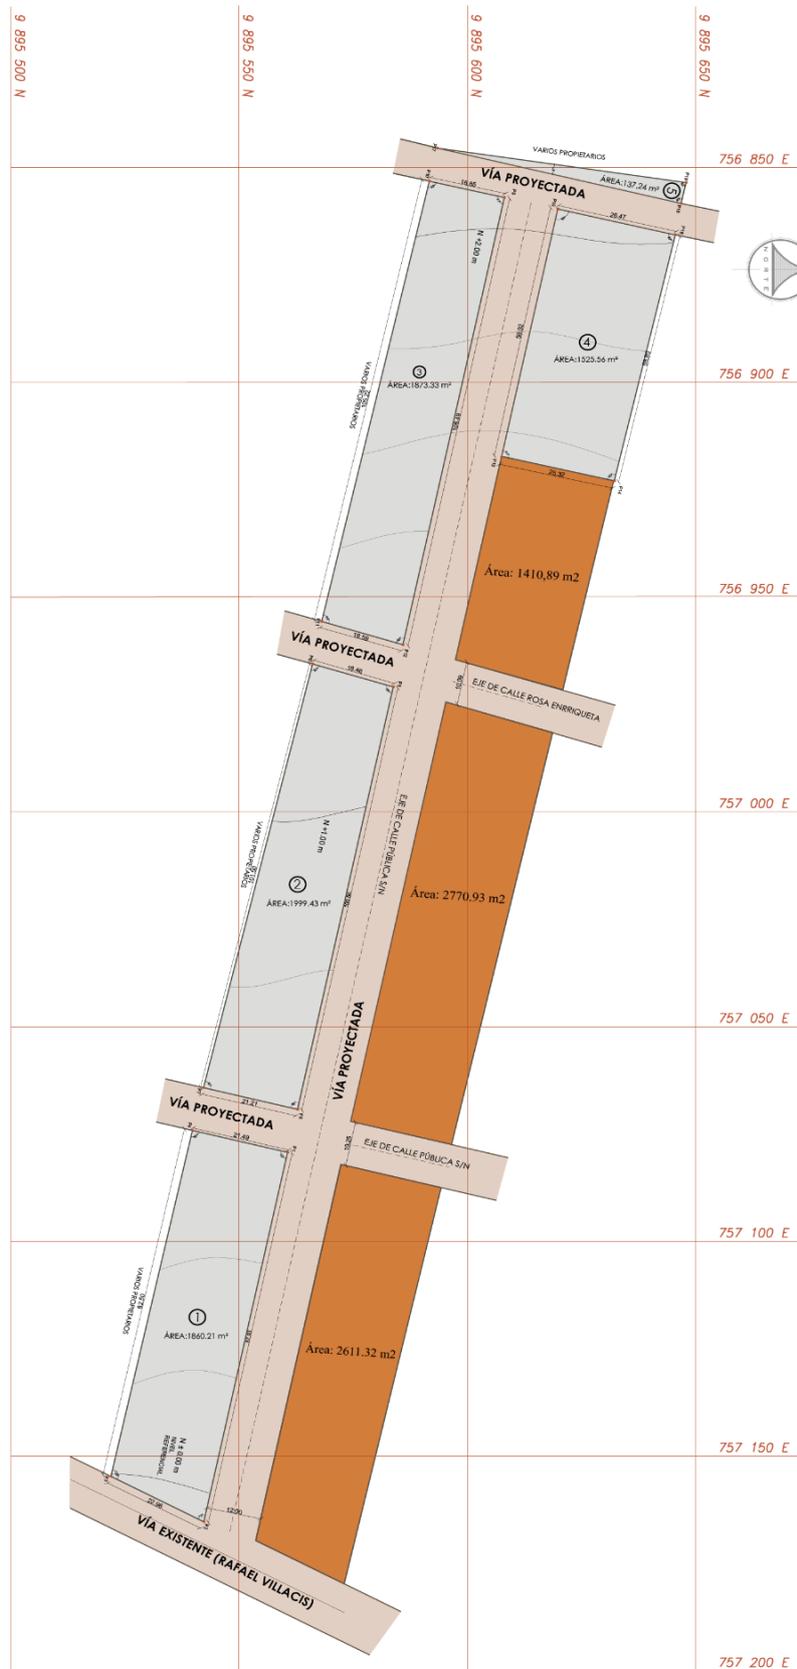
3. Levantamiento planimétrico del proyecto Guápulo segunda etapa
